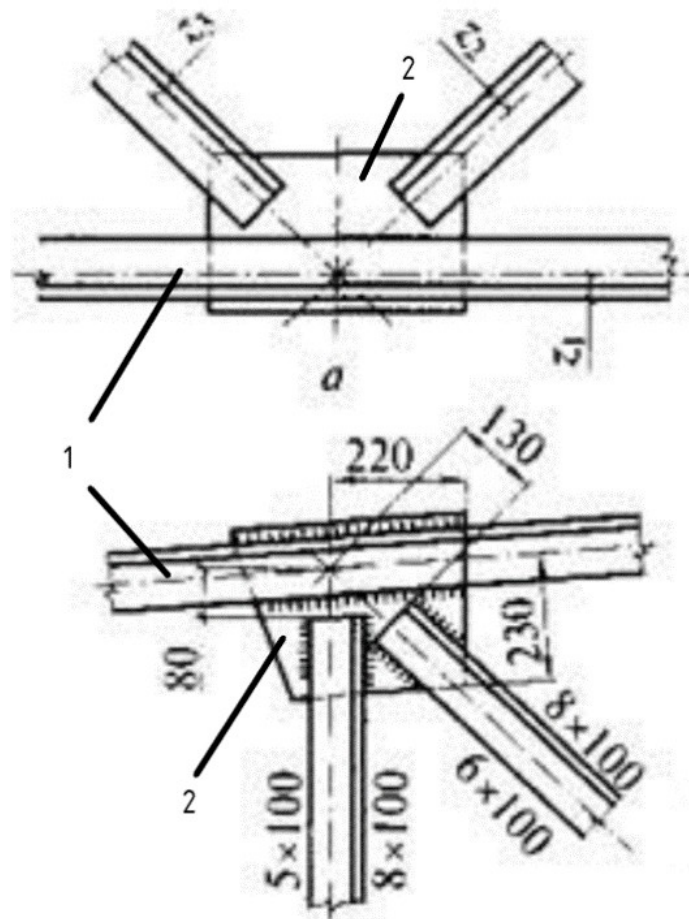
Узлы соединения решетки фермы с поясами:
